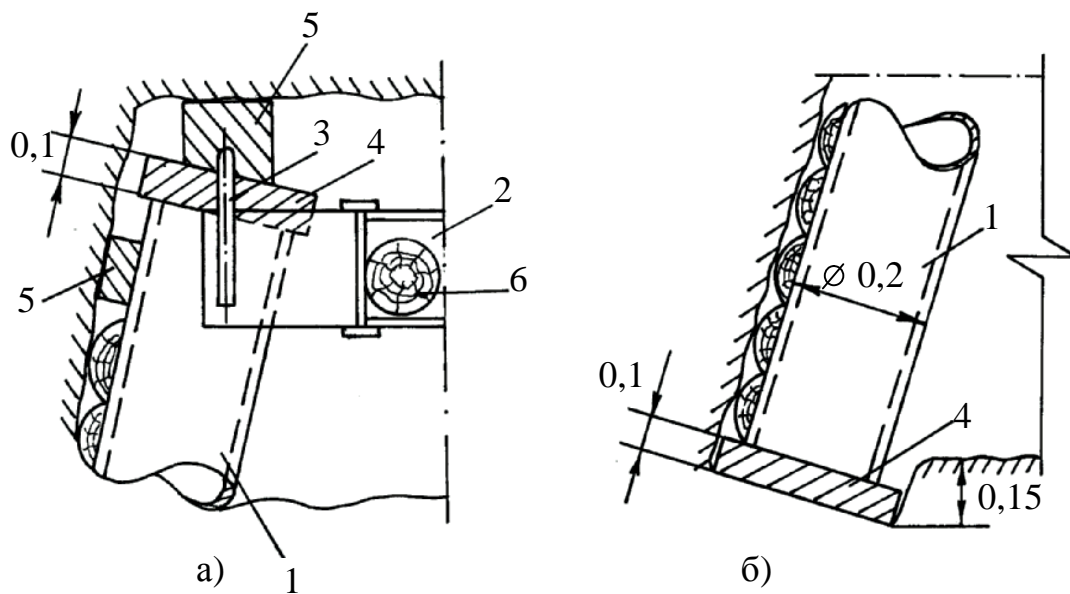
Схемы расклинивания замкового соединения металлического верхняка из двутавра и ЖБС (а) с выкладок деревянной подложки под основание стойки (б): 1 – ЖБС; 2 – верхняк из двутавра; 3 – опорная скоба; деревянные соответственно подложка (4), клин (5) и распорка (б)
